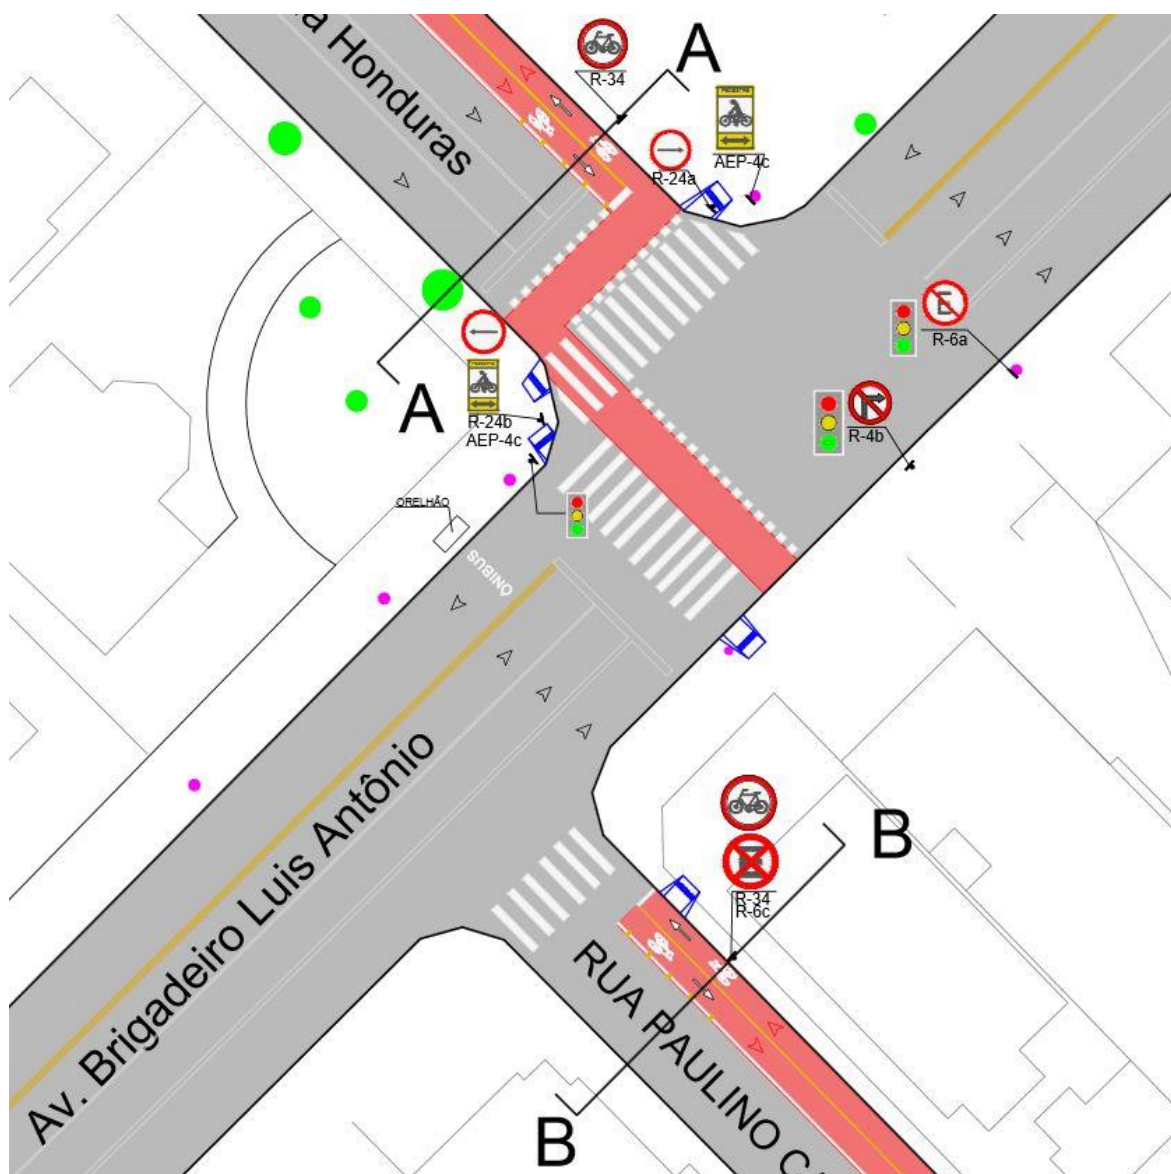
Planta do trecho 3 - Av. Brig. Luís Antônio x Rua Honduras (Fonte: Autoria própria)
